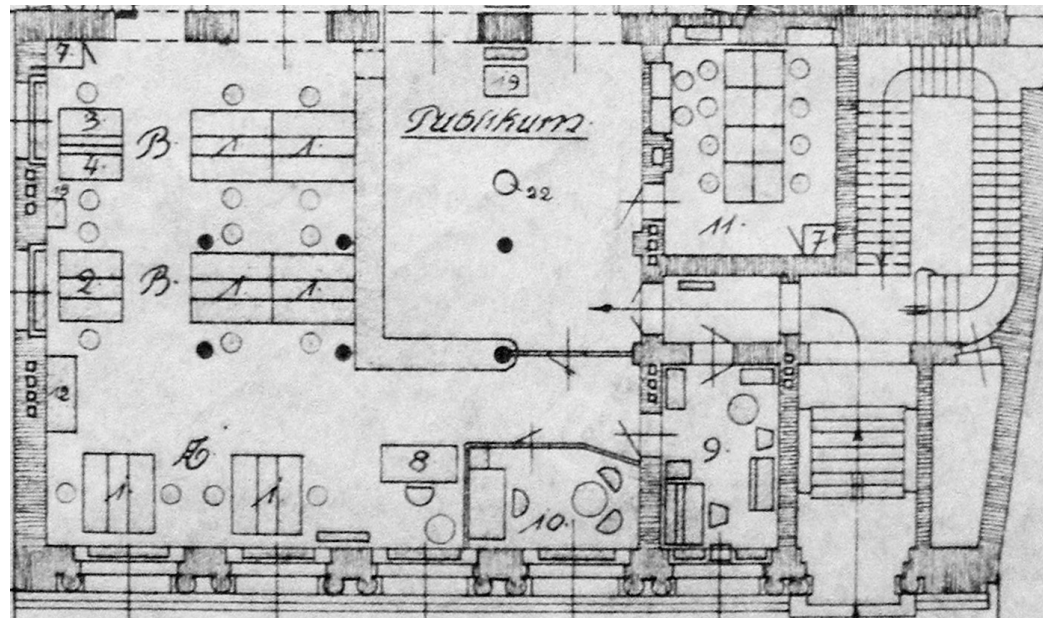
Ausschnitt des ursprünglichen, historischen Grundrisses, Max Hasak 1892
